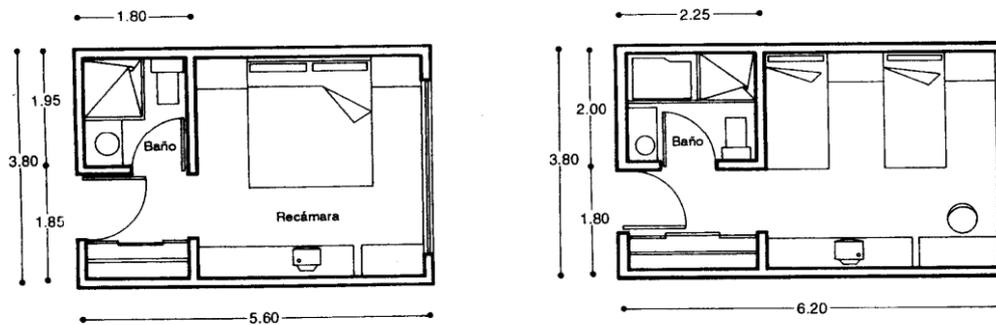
Planta tipo Habitaciones Parador Turístico
